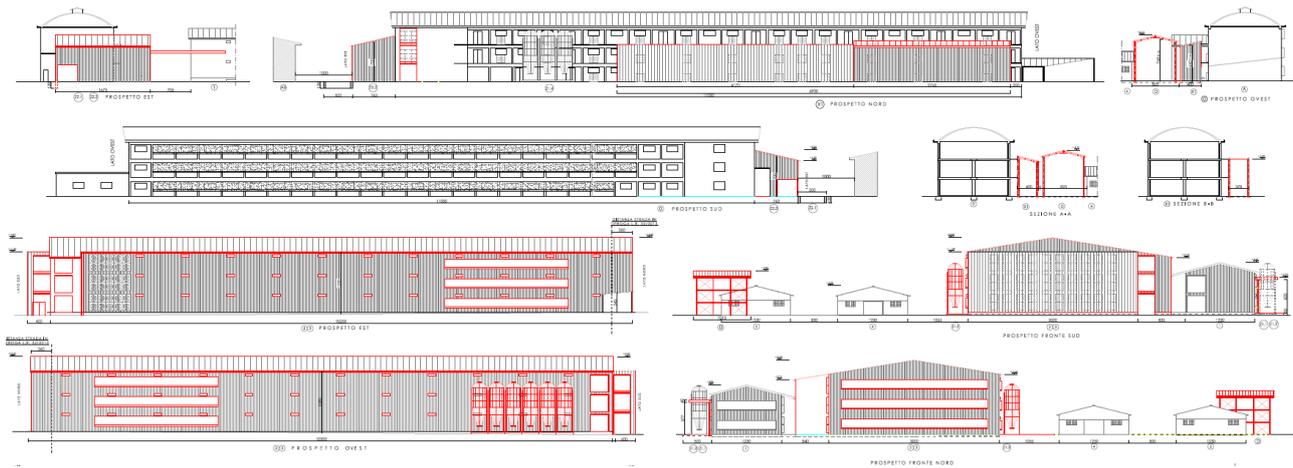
Estratto planimetria di progetto - Piante/prospetti/sezioni
